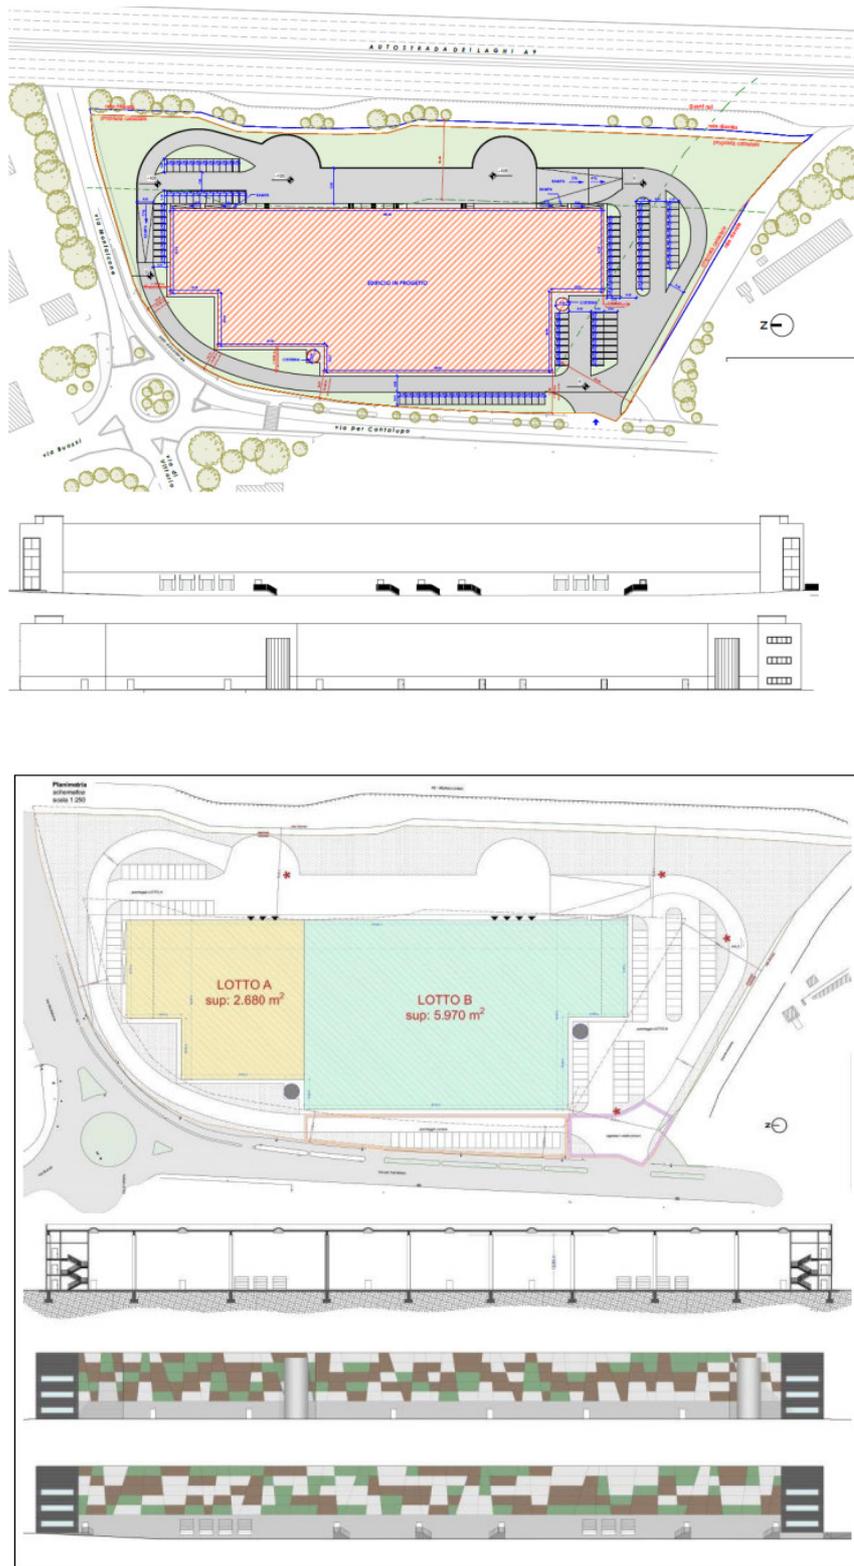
Planimetria , sezioni e prospetto del progetto
